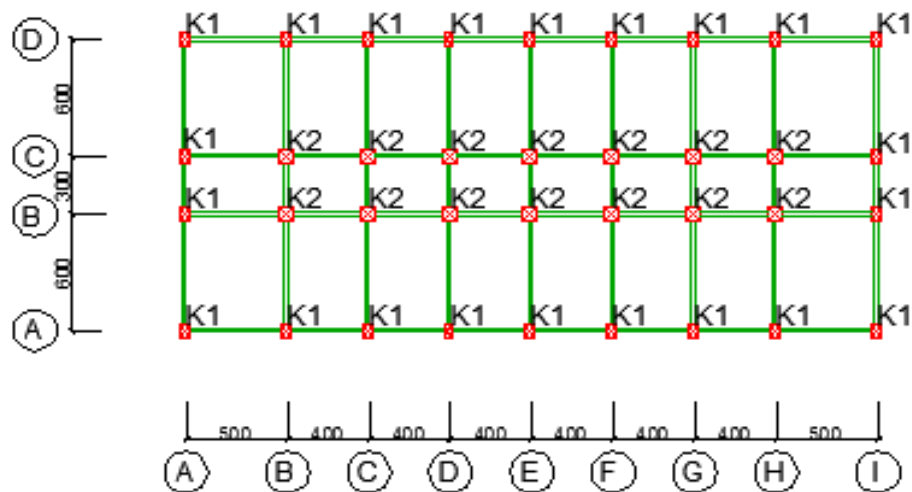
Denah Balok B2 Pada lantai 2-6
